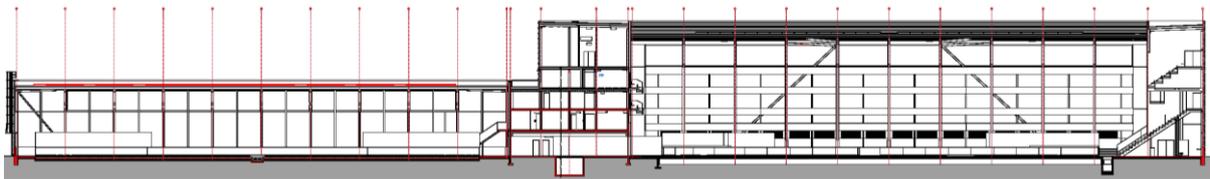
Vue en coupe du complexe, plan Dolci Architectes
